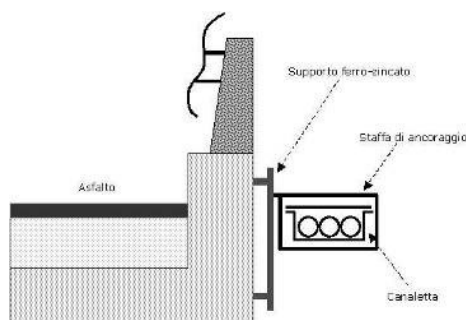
Infrastrutture per attraversamento di ponti/viadotti
